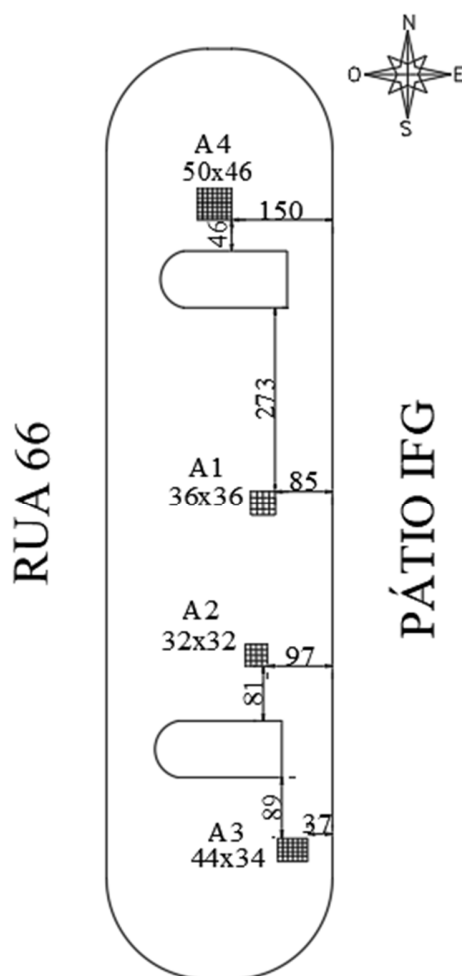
Localização das áreas ensaiadas para o ensaio de esclerometria
